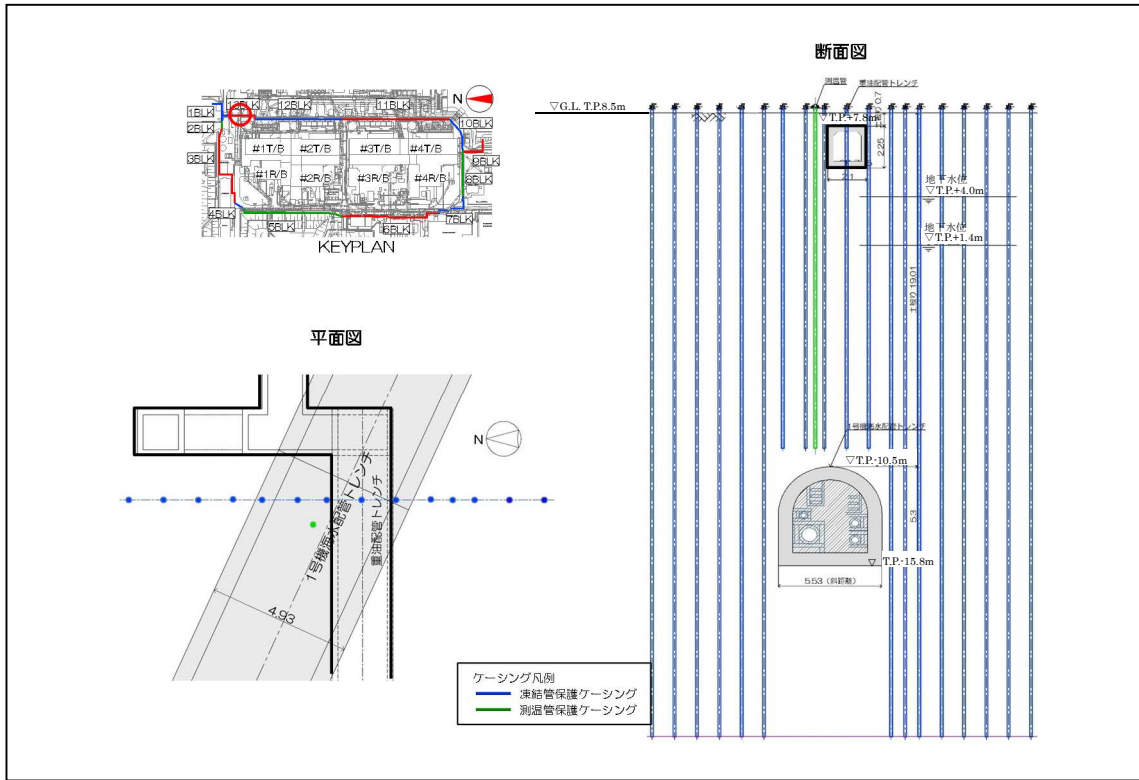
1号機海水配管トレンチ部 施工平面図・断面図
